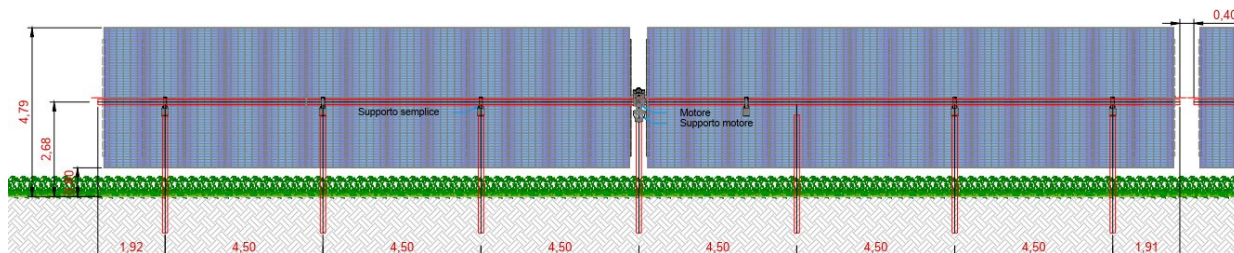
Sezione trasversale tipologica struttura Tracker
